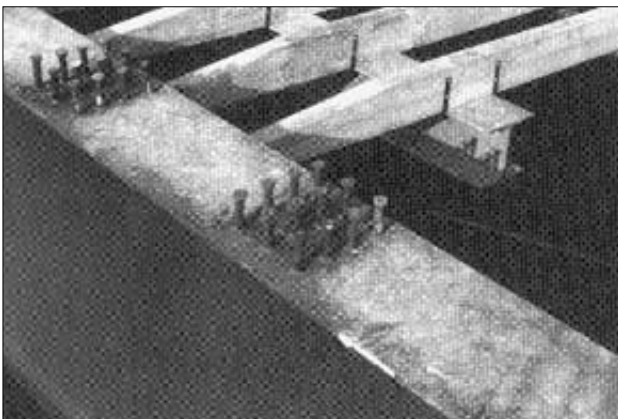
Connecteurs soudés en atelier (photo: ICOM-EPFL).
